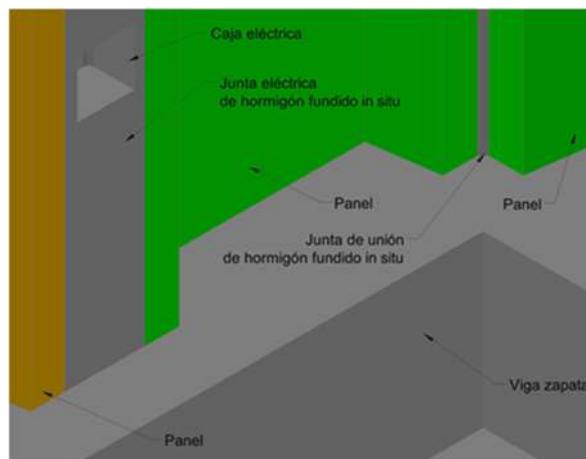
Detalle de la junta de hormigón entre paneles para la colocación de instalaciones y cajas eléctricas.
